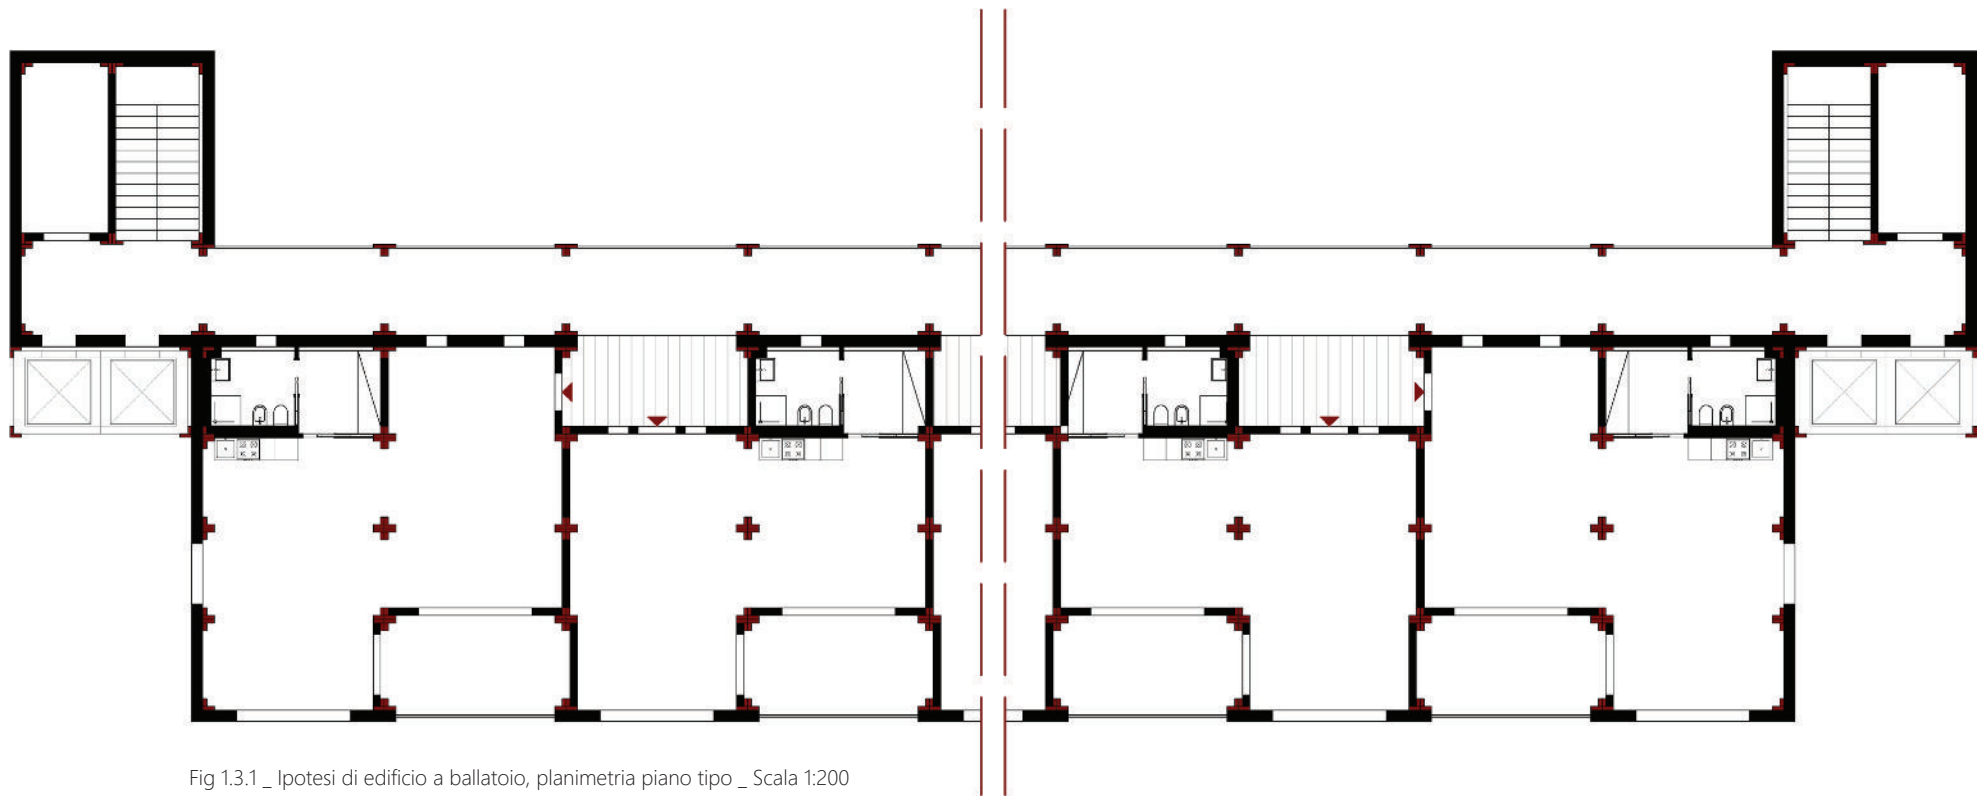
\_ Ipotesi di edificio a ballatoio, planimetria piano tipo \_ Scala 1:200
